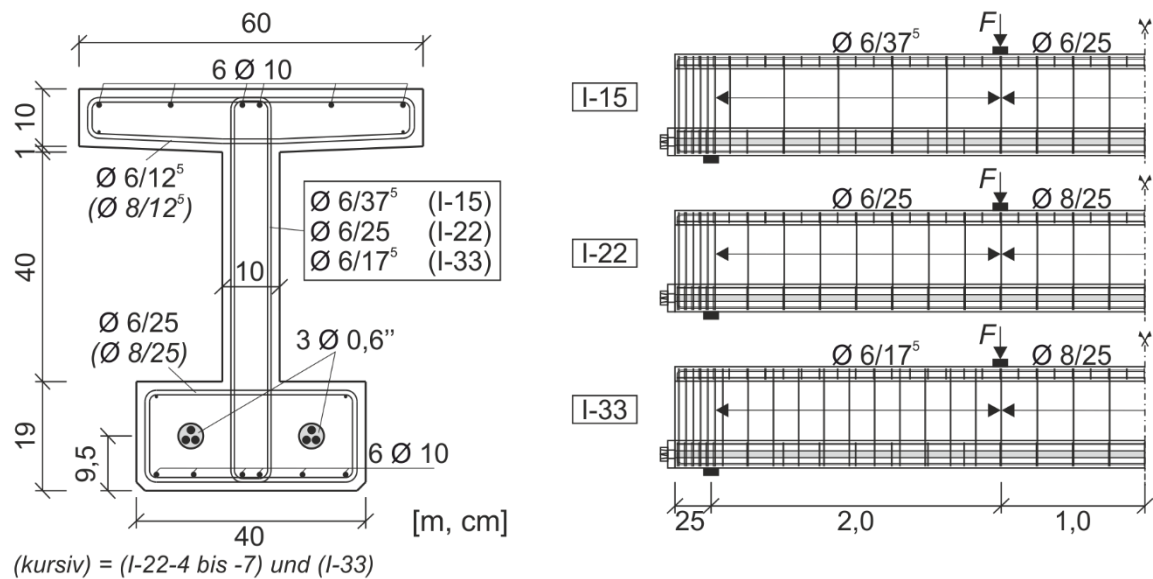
Querschnitt und Längsschnitt der I-Träger mit Querkraftbewehrung
